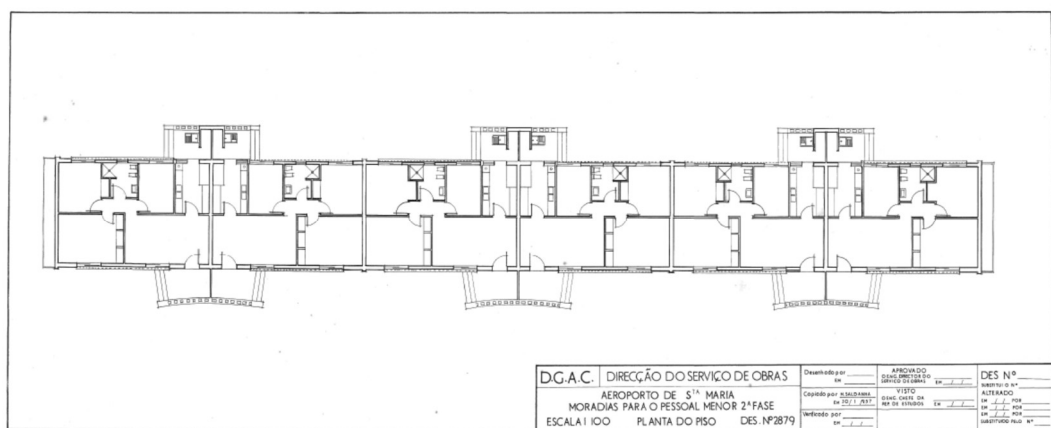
Planta Tipo das Habitações em Banda do Bairro Infante D. Henrique (Ilhas de Valor)
